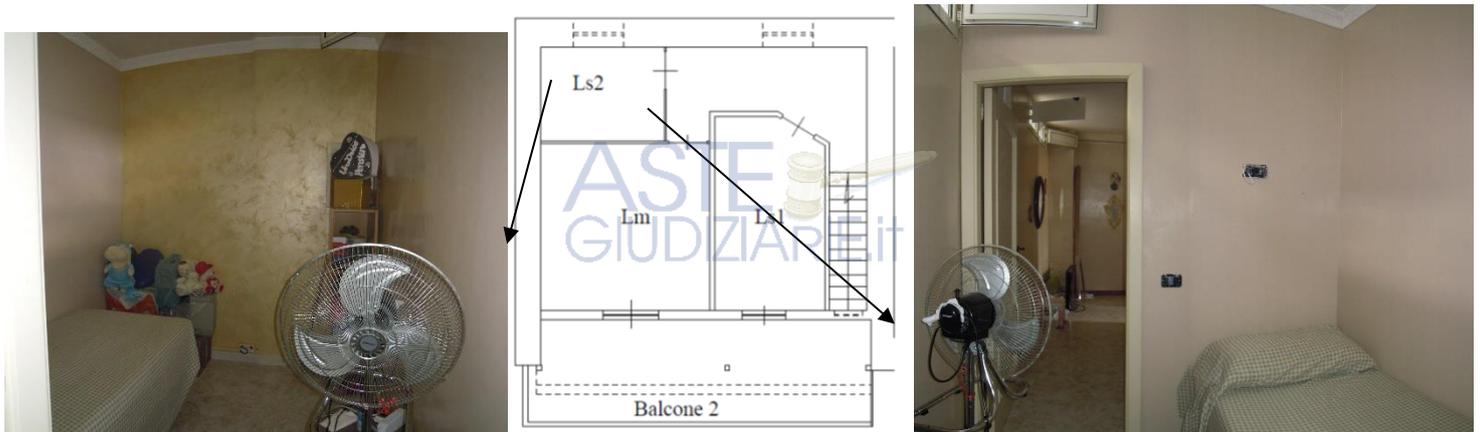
Individuazione fotografica degli interni dei beni oggetto di pignoramento.
